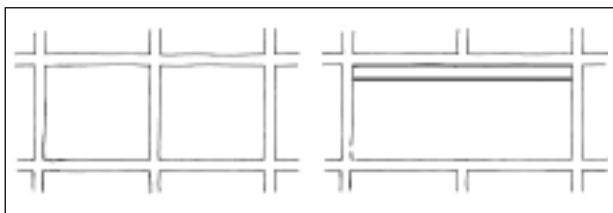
Cambio en la geometría existente por apeo de un pilar.
